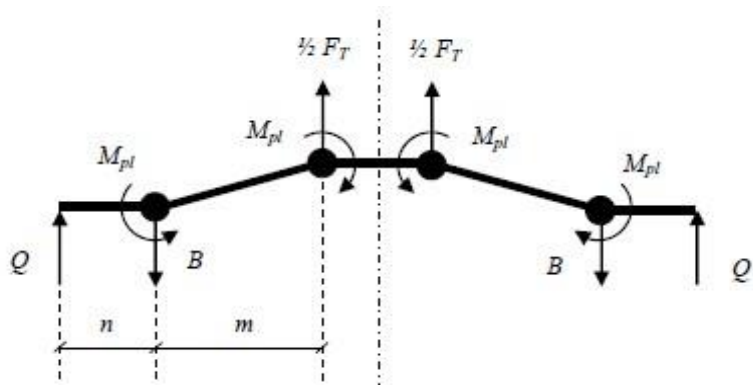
Modelo de colapso del T-Stub.
